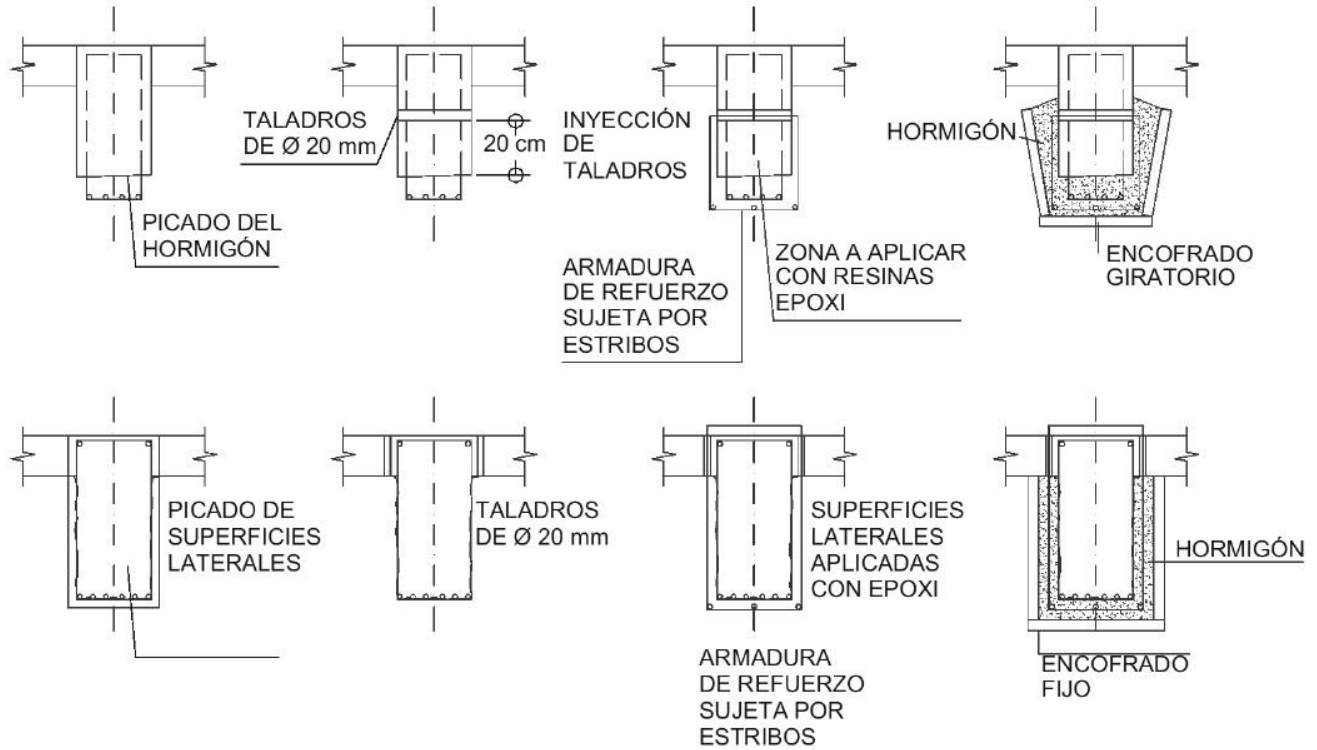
Adición de armaduras de refuerzo con recrecido de la sección de la viga.
